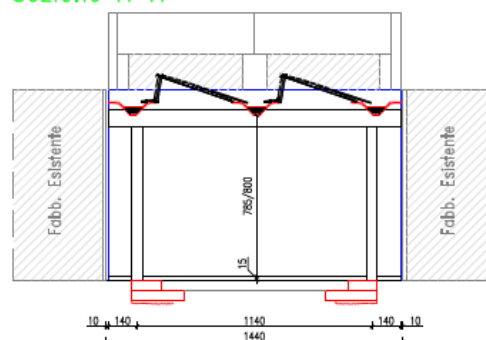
c – planimetria di progetto relativo all'ampliamento dell'area da adibire al montaggio e verifica di nuovi prodotti
